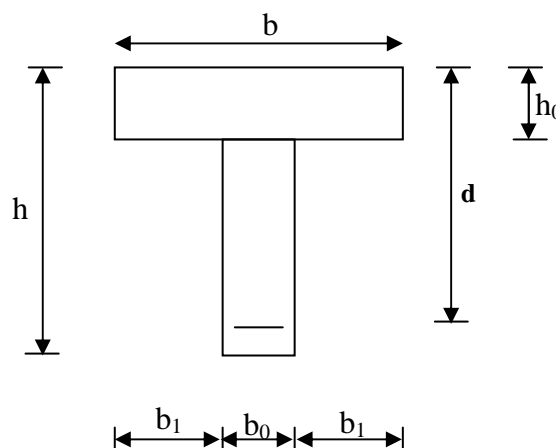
Section de calcul de la poutrelle en travée après Coulage de la dalle de compression
